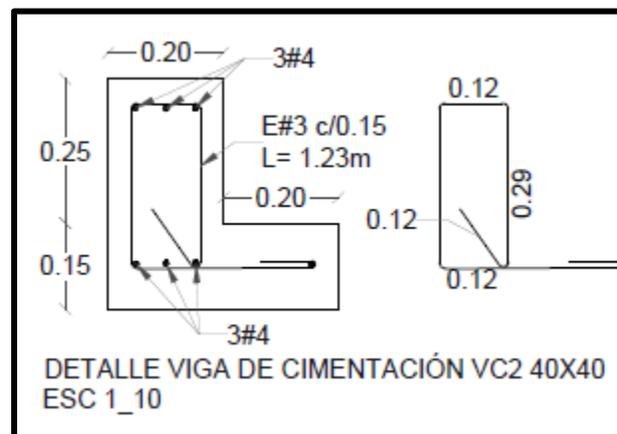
Detalle de Viga de Cimentación Tipo VC
